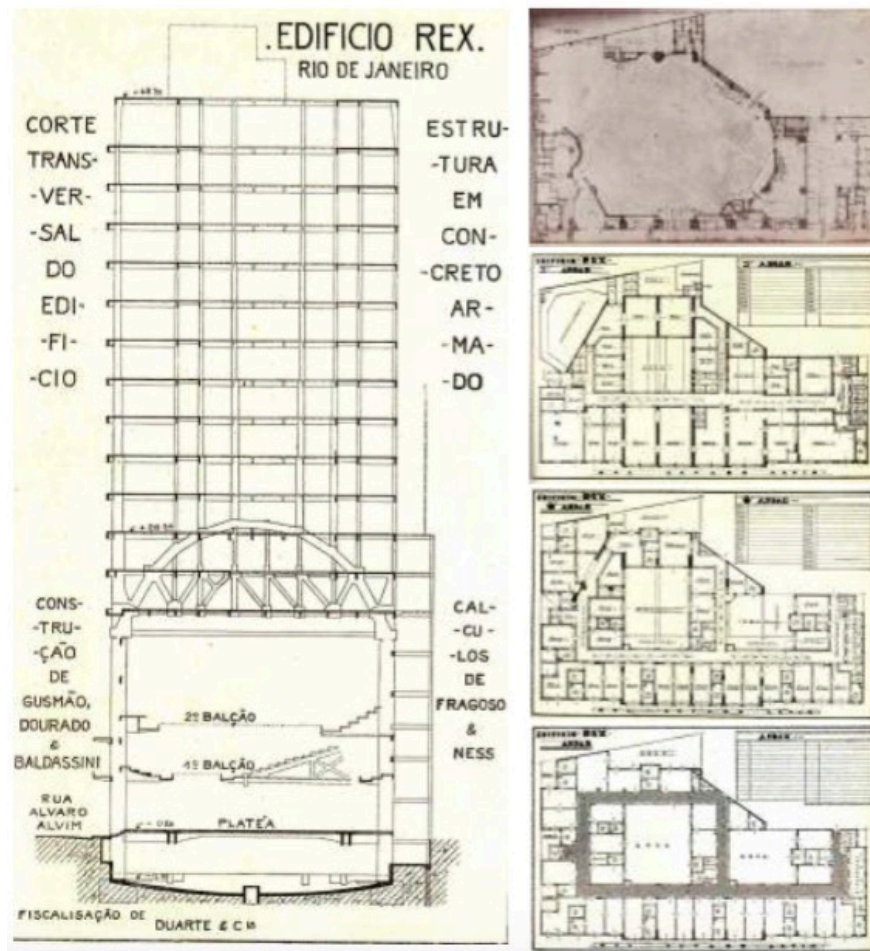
Edifício Rex, 1930. Corte transversal e plantas. FONTE: Revista Casa apud SANTOS, 2008.
